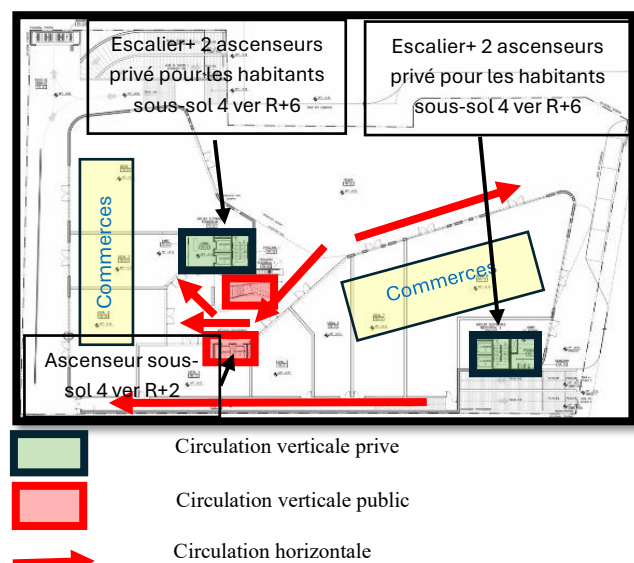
surcirculation vertical + horizontal privé / public plan RDC source : www.archdaily.com traite par les auteurs
